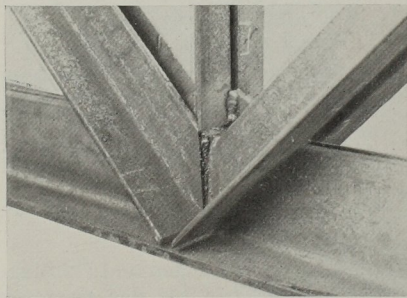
Ungünstig geschweißter Knotenpunkt
